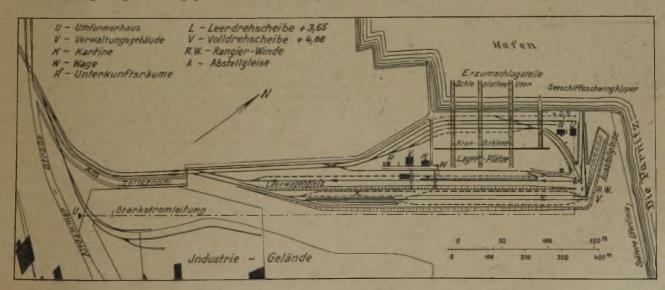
Lageplan des Reiherwerder Hafens zu Stettin.
